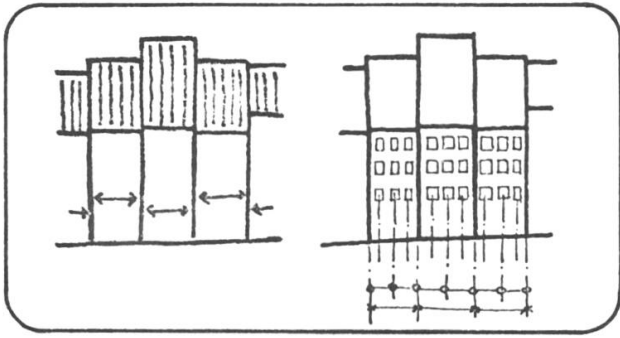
, Regeln Ablebarkeit und symmetrische Fassadengliederungen
